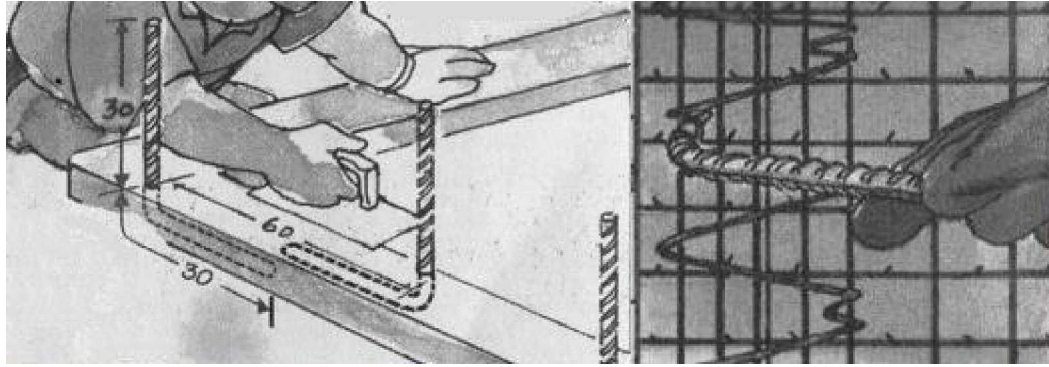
ARMADO DEL MURO DE CONVINTEC
